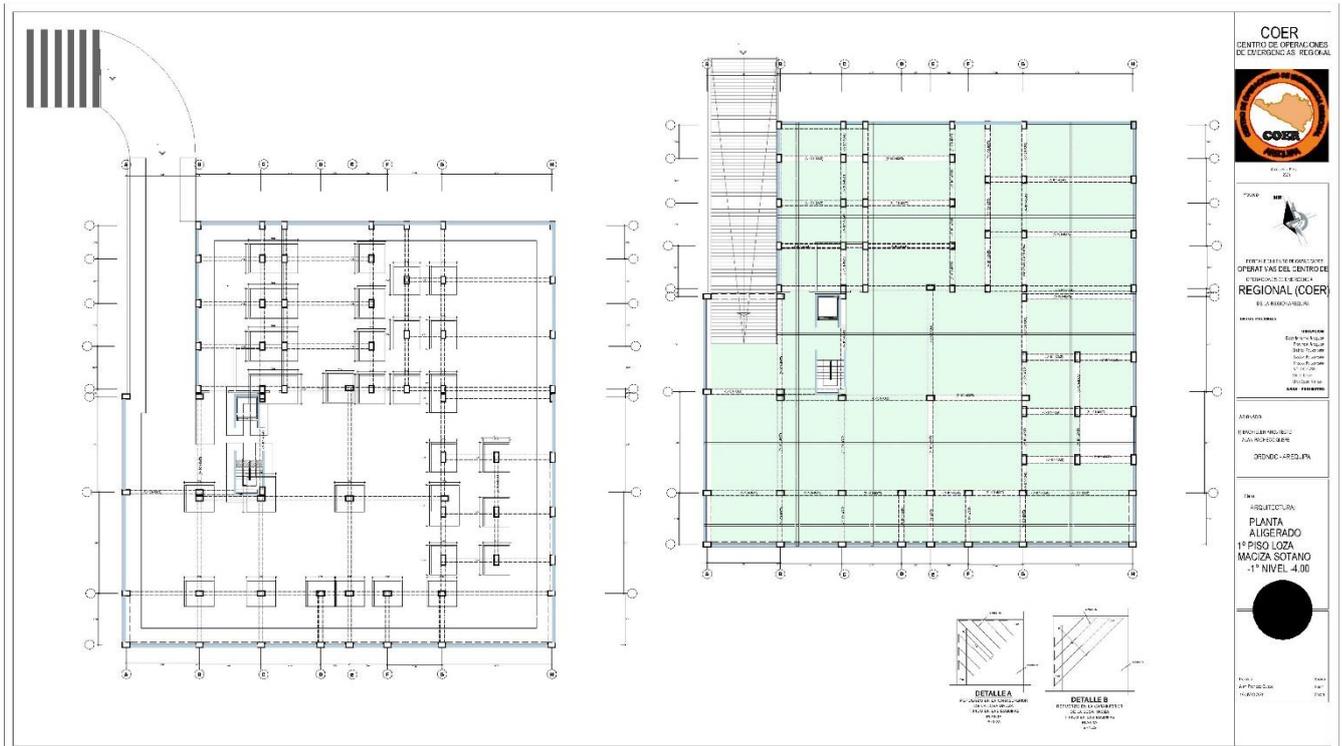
Aligerados N.º piso Losa Maciza Sótano
